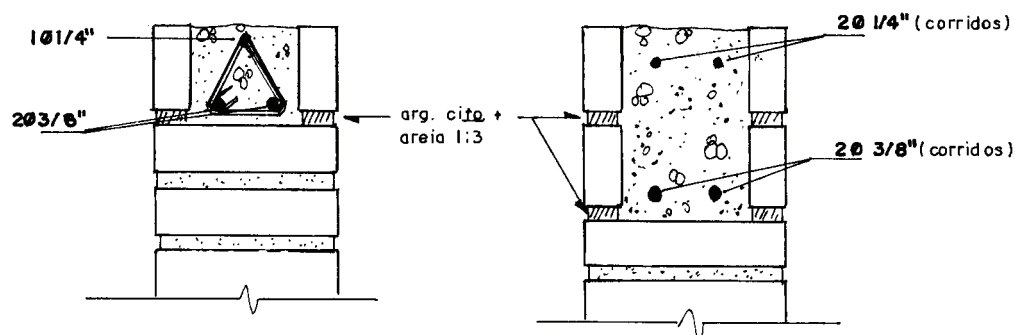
Cinta de amarração em alvenaria de bloco de concreto
